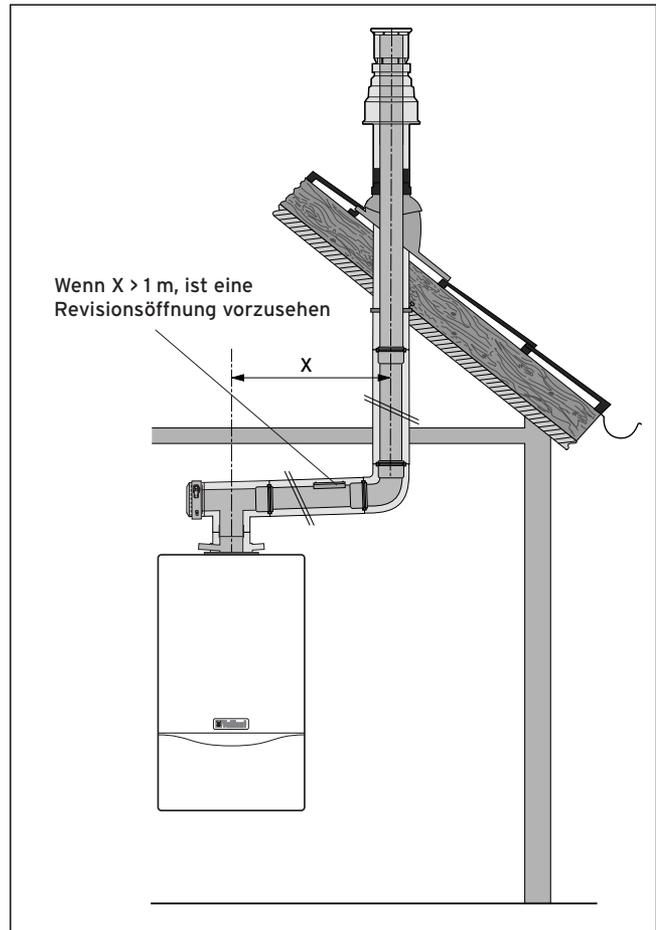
Montagebeispiel: Senkrechte Dachdurchführung
